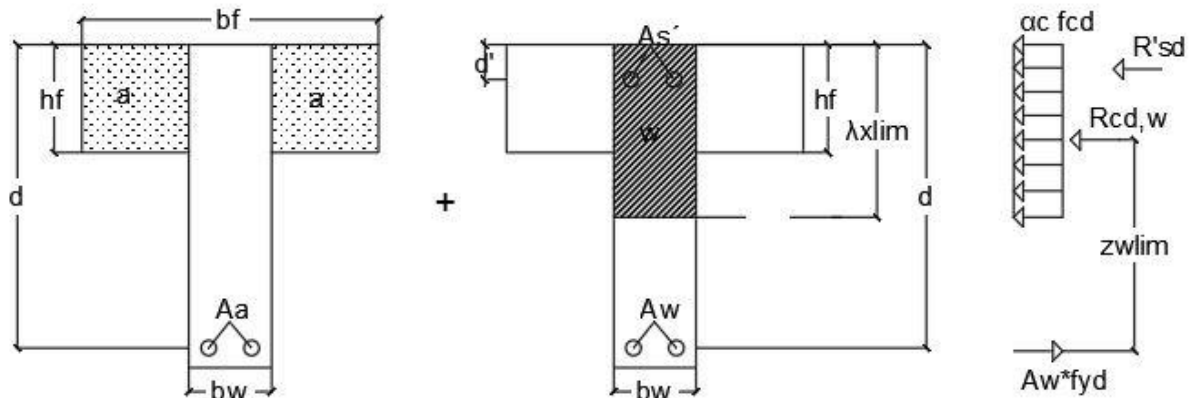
Armaduras seção T (Elaborado pela autora, 2018)
